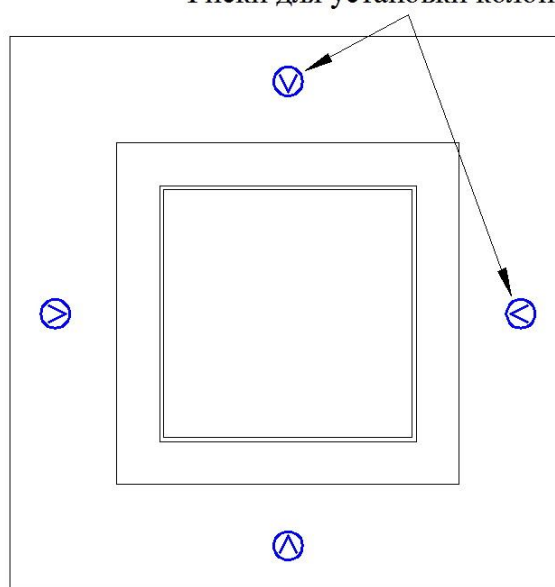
Фундамент (вид сверху) с закрепленными осями колонн
